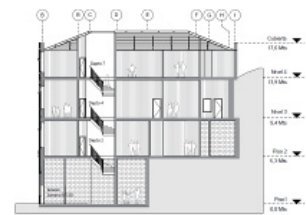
Planta y corte edificio Serrano #558. Fuente: Gallardo 2015.
